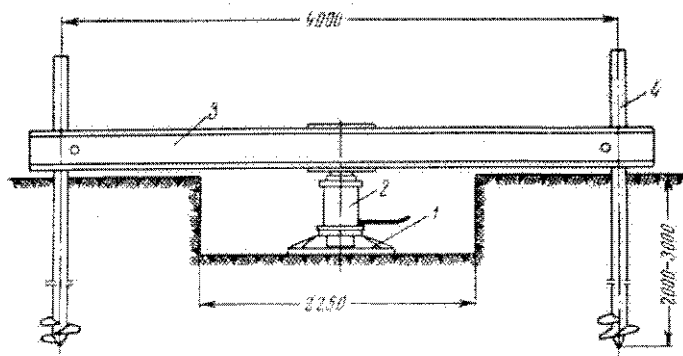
Схема установки для испытаний пород пробной нагрузкой в шурфе
